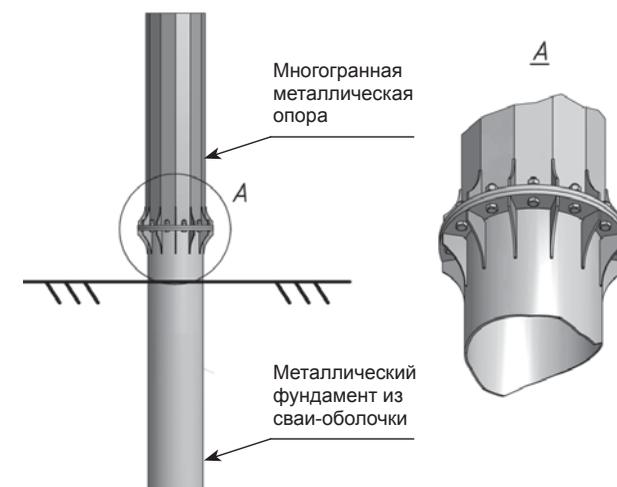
Схема фундамента из сваи-оболочки трубчатого сечения
